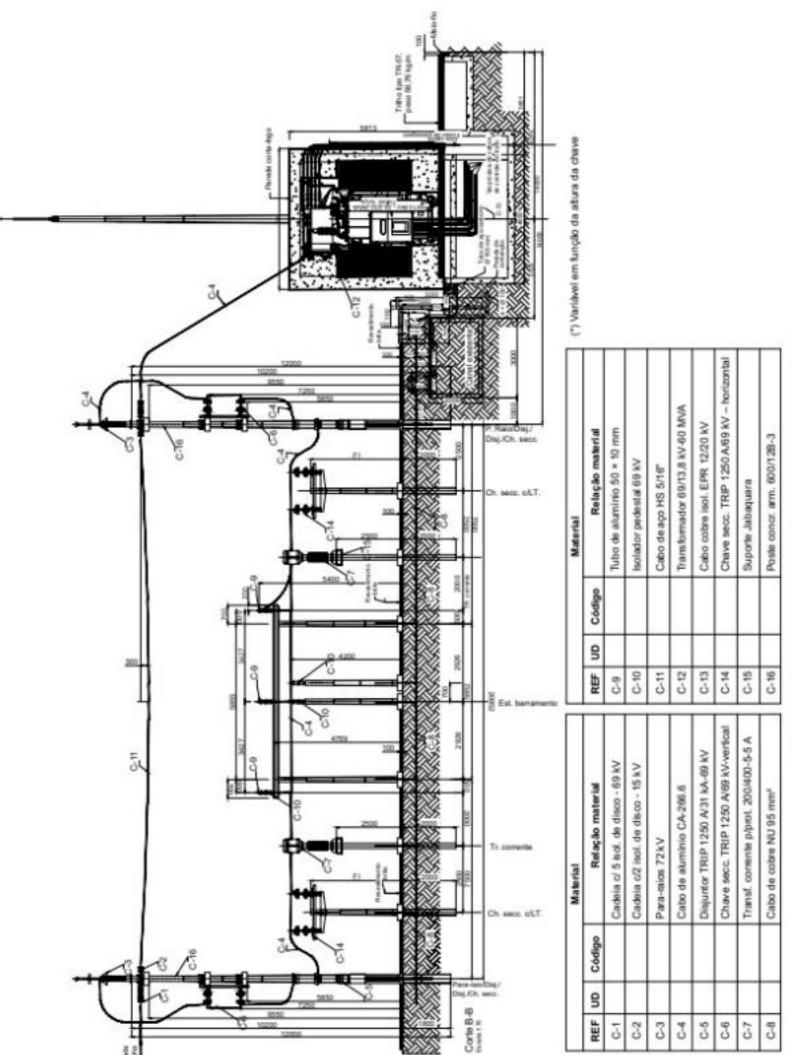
,3 Subestação em estrutura de concreto armado – vista lateral.
